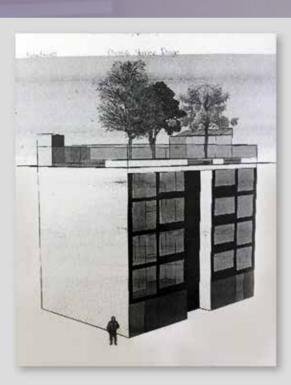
y 5b. Proyecto de innovación. Ejemplo de un plano y la respectiva maqueta de las construcciones con azotea verde.
